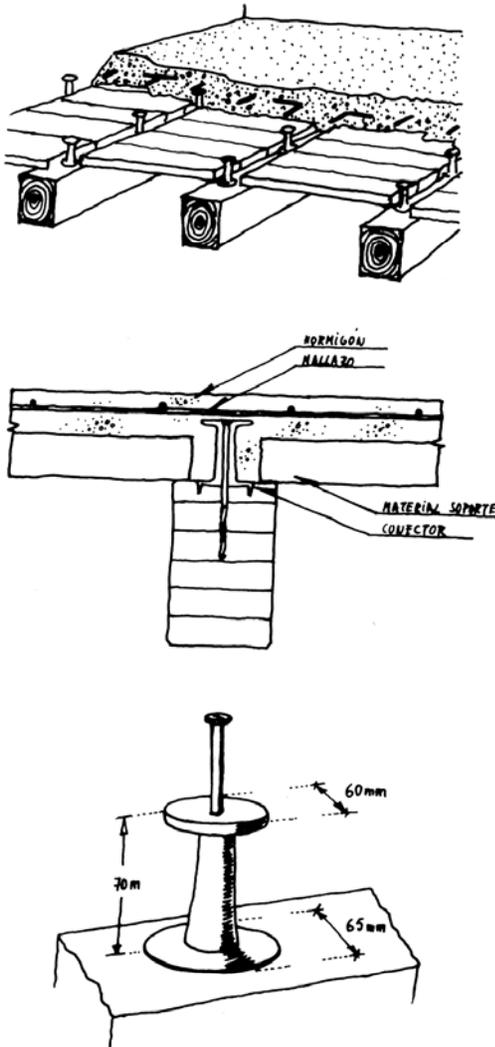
Sistema H.S.B. para la conexión entre madera y hormigón.
